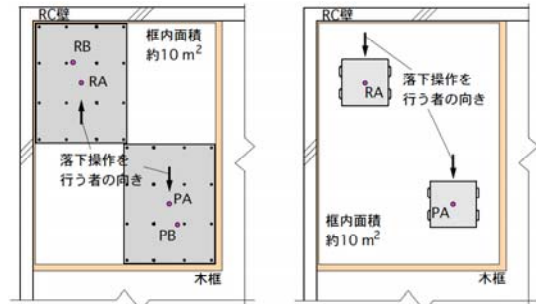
試験体の設置位置(二重床、コンクリートパネル浮床)
